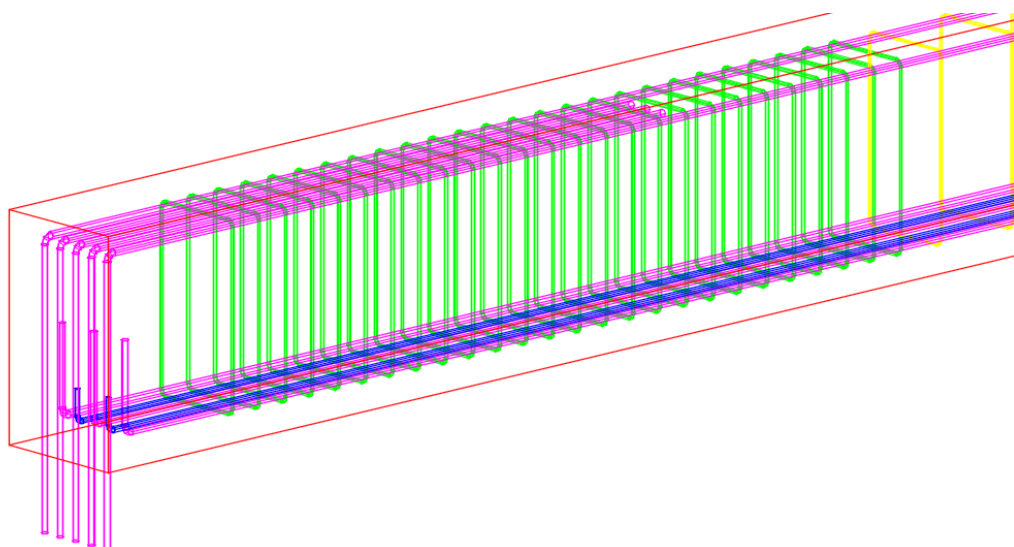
Pormenor viga completa barras (5, 6 e 7) – extremidade esquerda.
